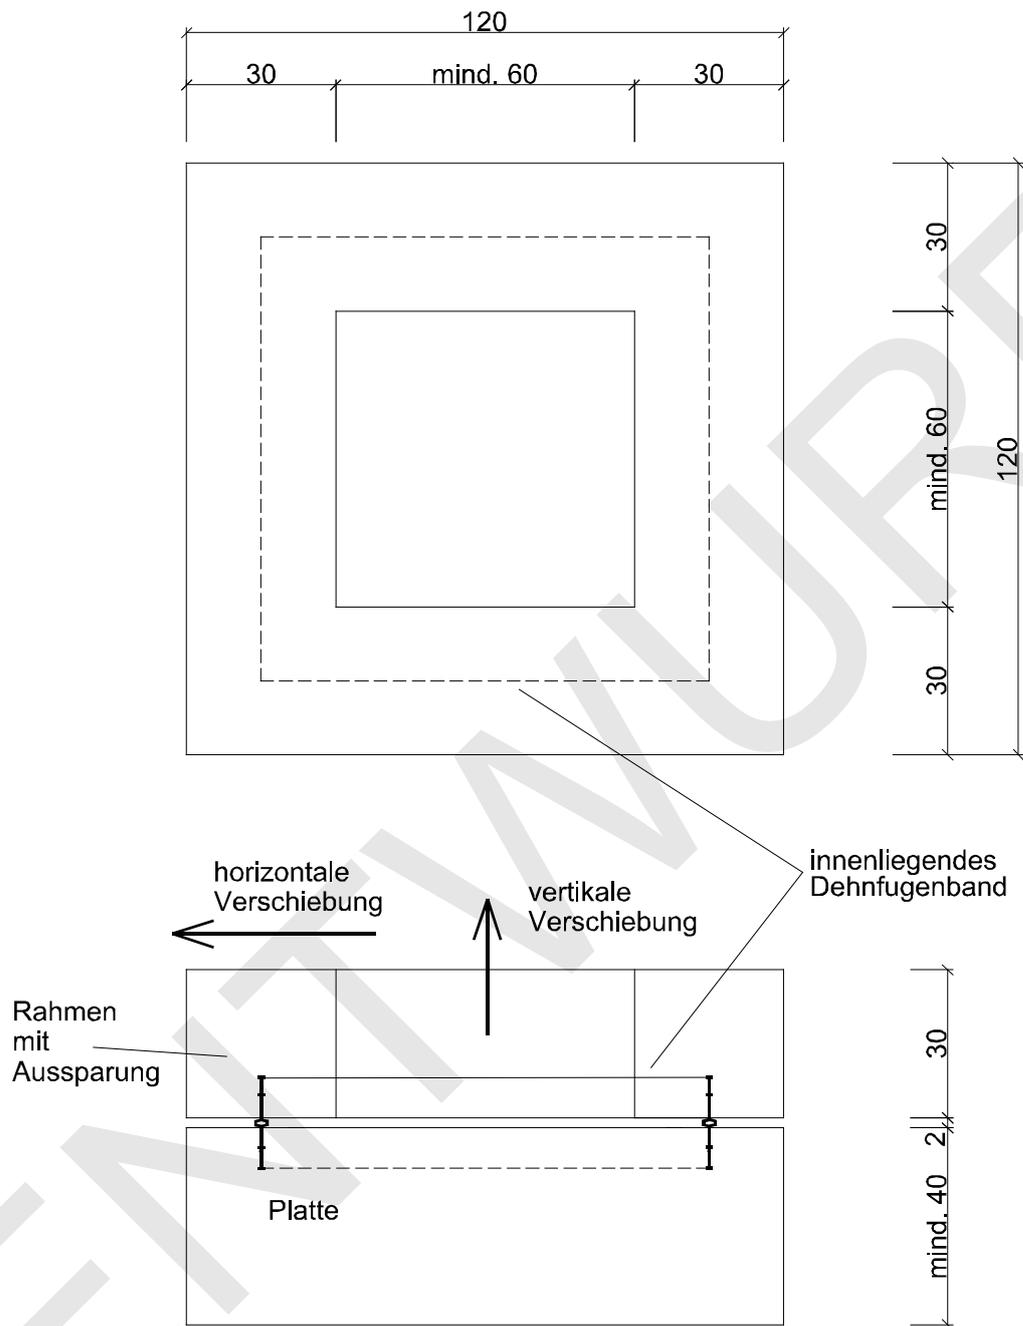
Prüfkörper für im Beton verankerte Systeme, Prinzipskizze
